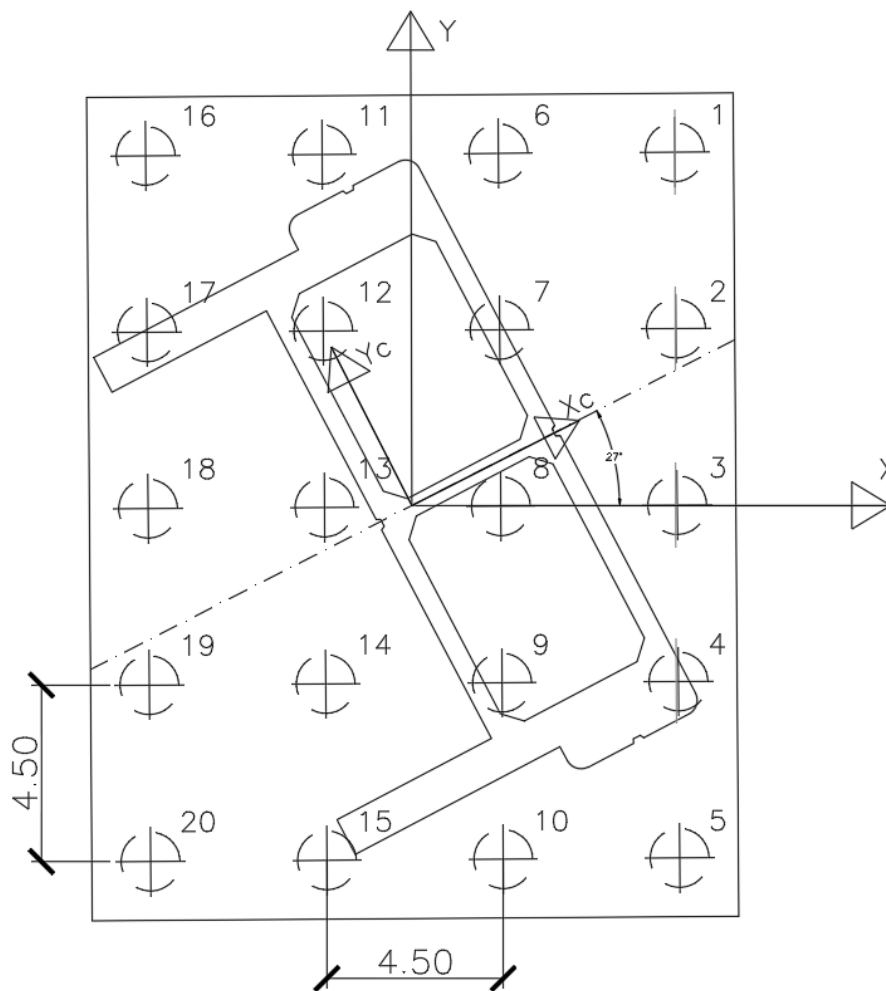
pianta pali pile P15 e P16 a 20 pali
